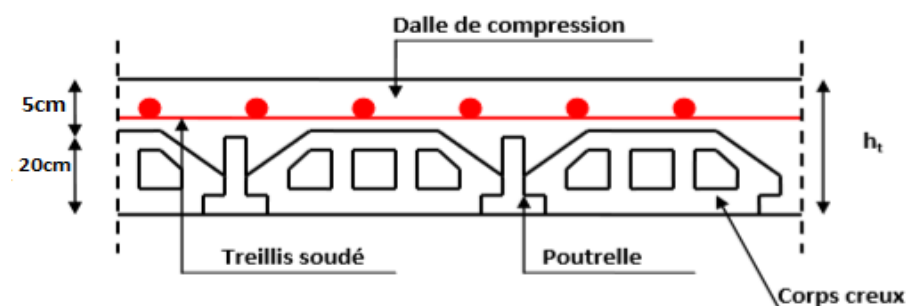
Coupe transversale d'un plancher à corps creux.
